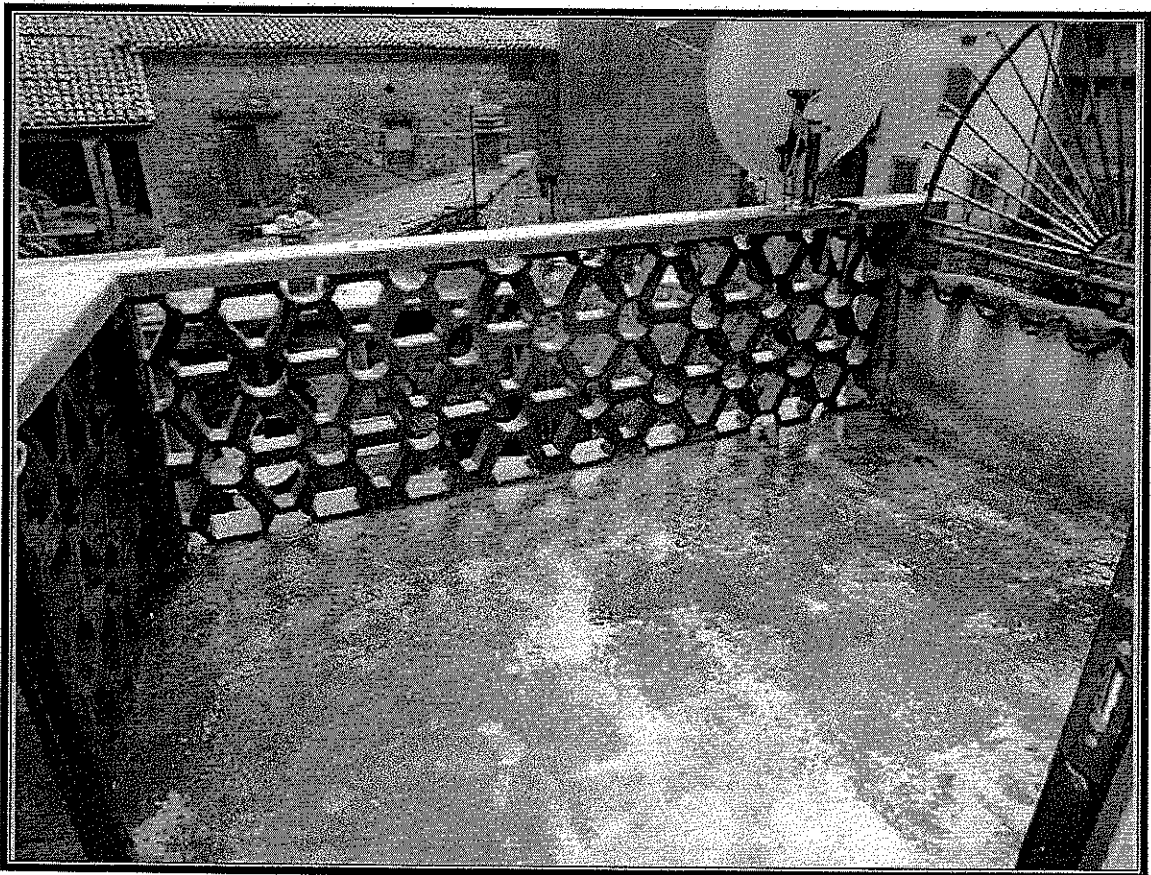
locale camera n.3 – 1<sup>^</sup> piano
